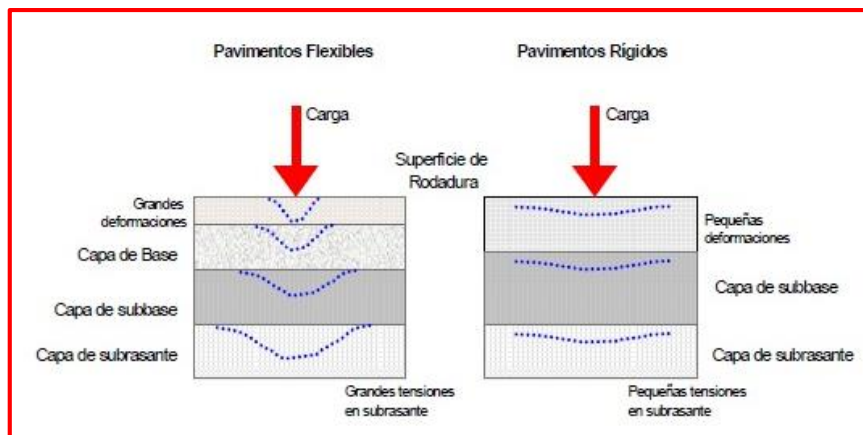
Esquema de comportamiento de pavimentos flexibles y rígidos
